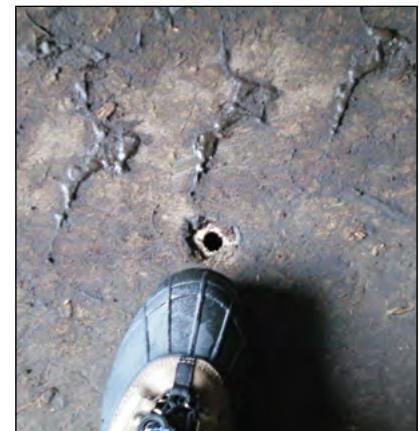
Aération intégrée au sol avec un système de tuyaux et d'embouts; la photo intérieure montre un système avant le versement du plancher en béton. © CH2M HILL
